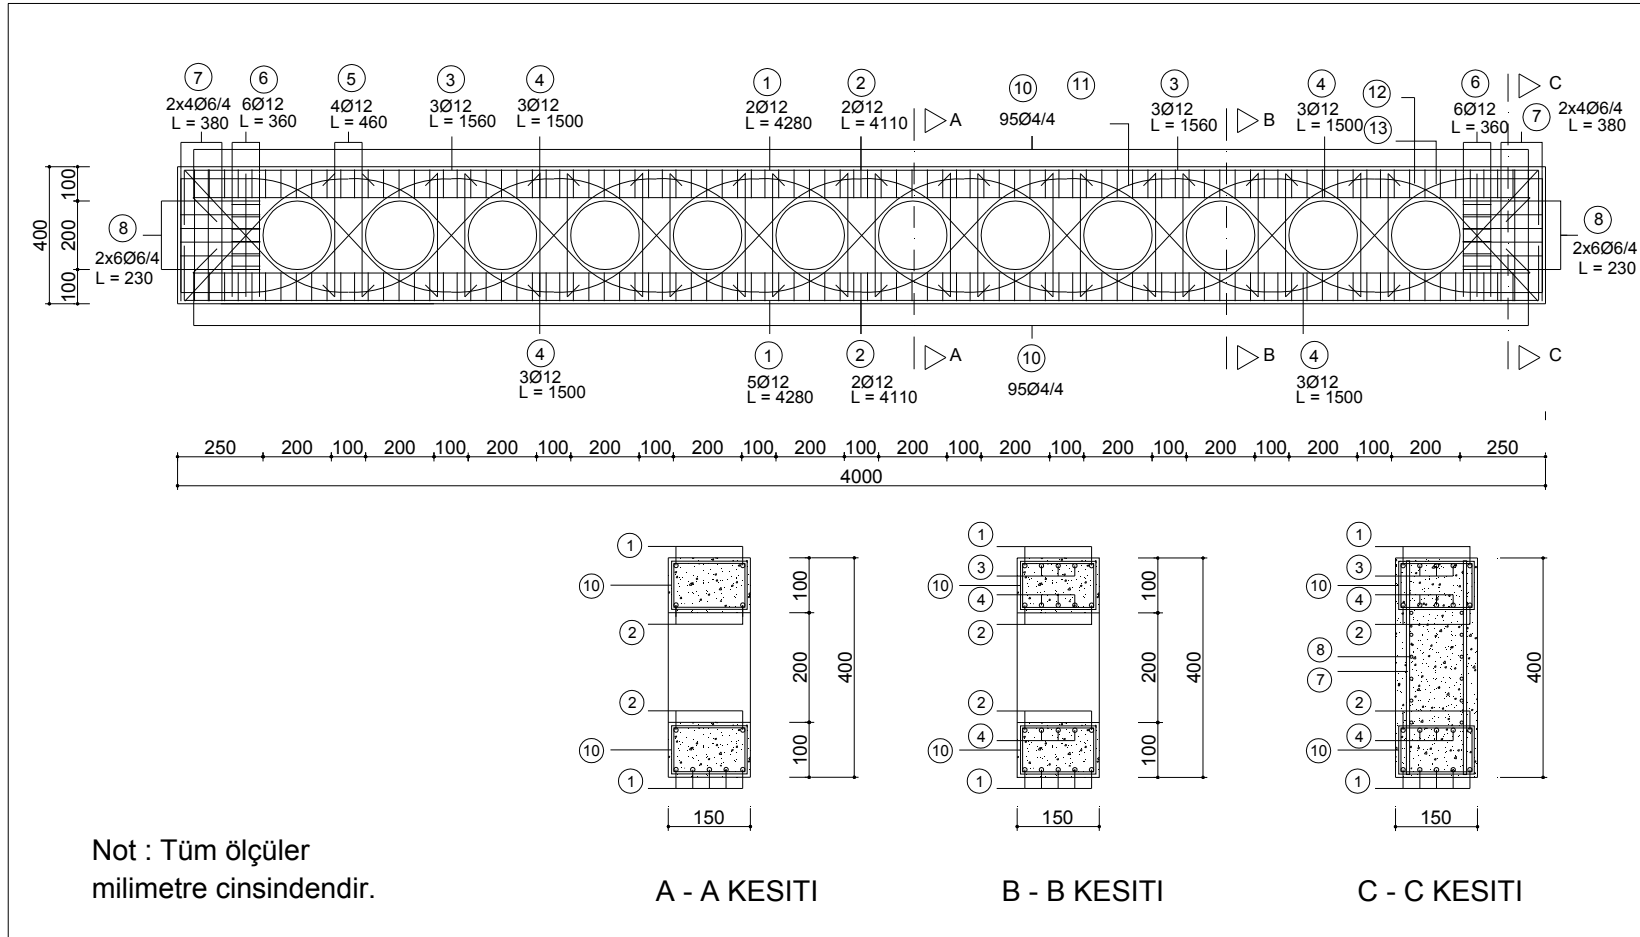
RCcb kiriş donatı planı ve kesitleri
